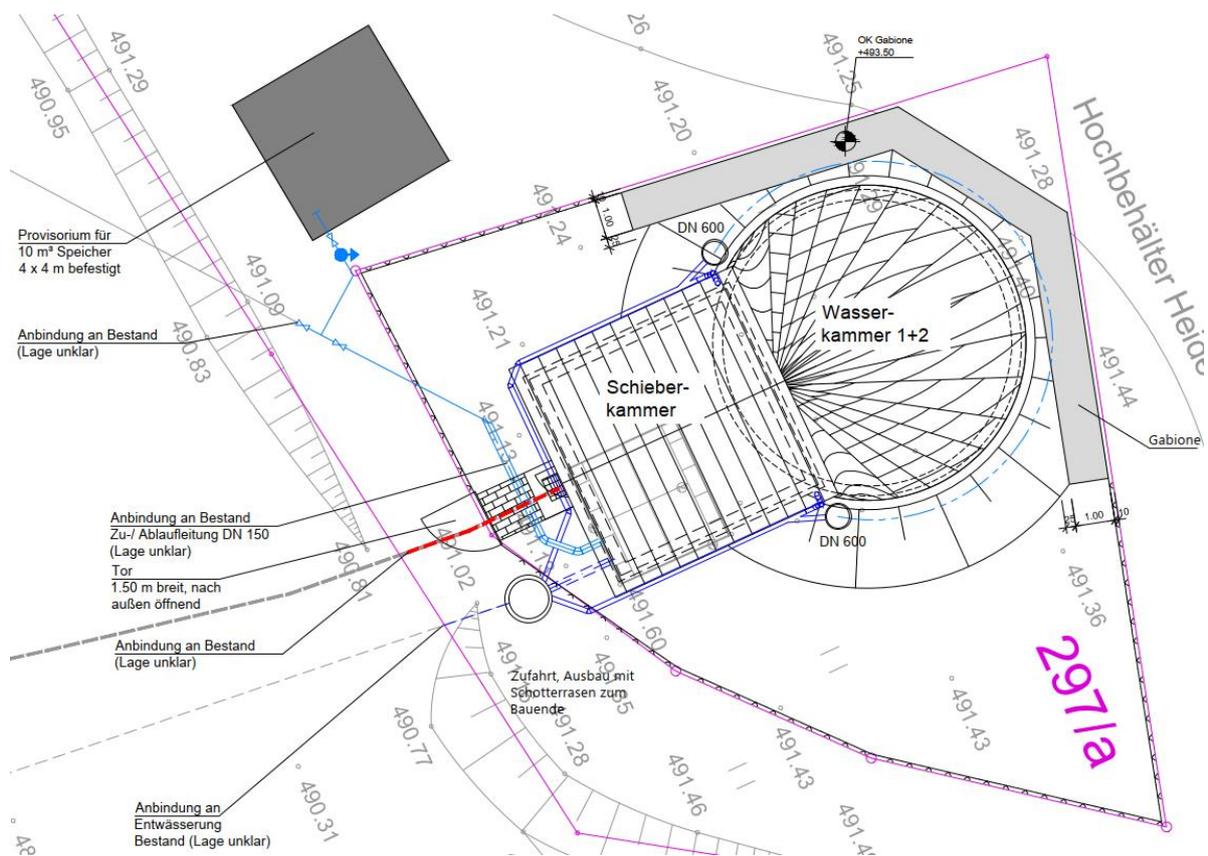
Lageplan Ersatzneubau Hochbehälter Heide
